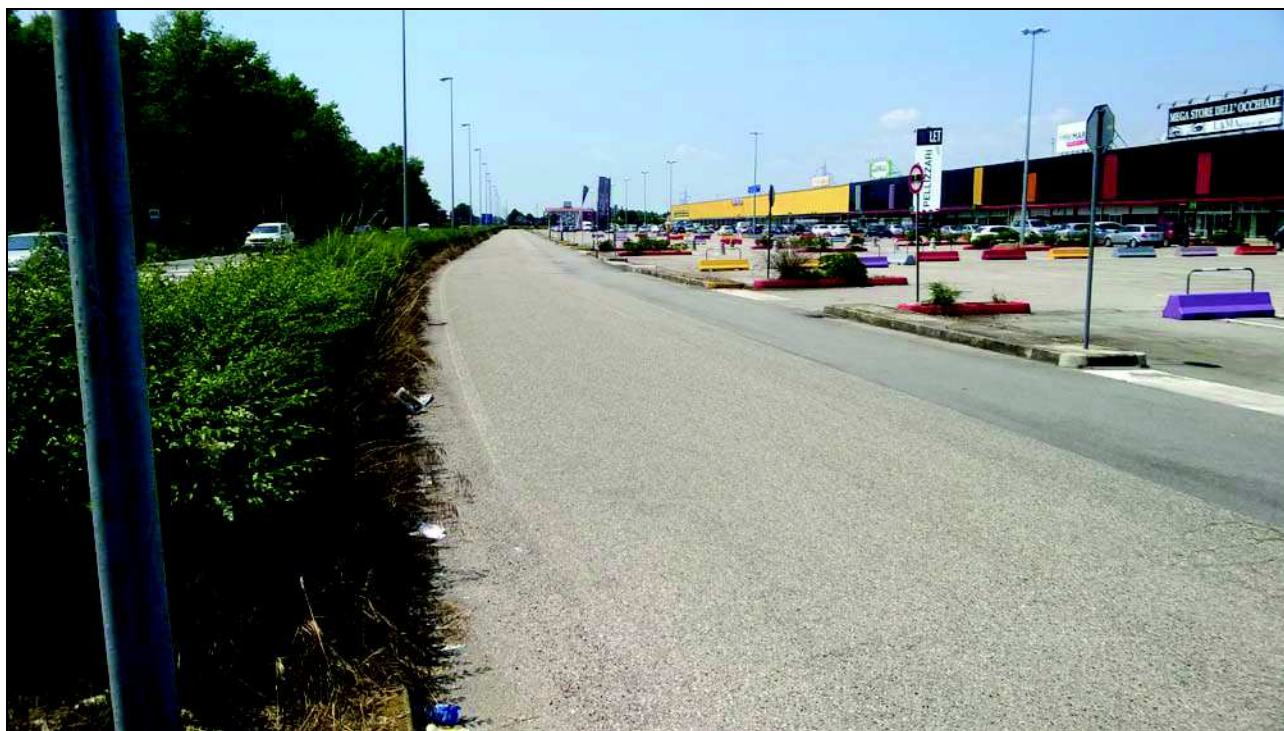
Strada interna di accesso all'area commerciale: vista da est verso ovest
